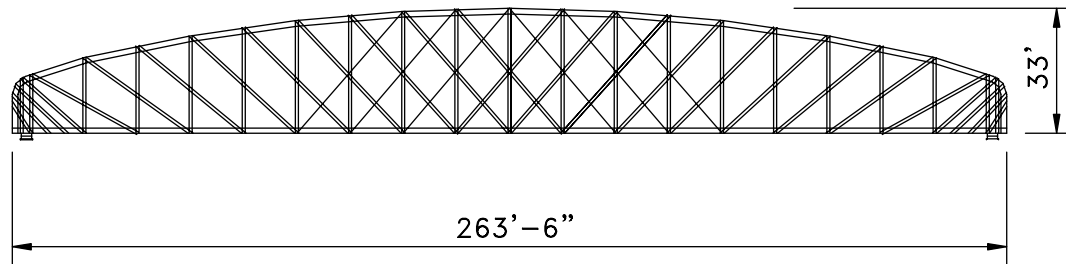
Pont Turcot sur la rivière Châteauguay
